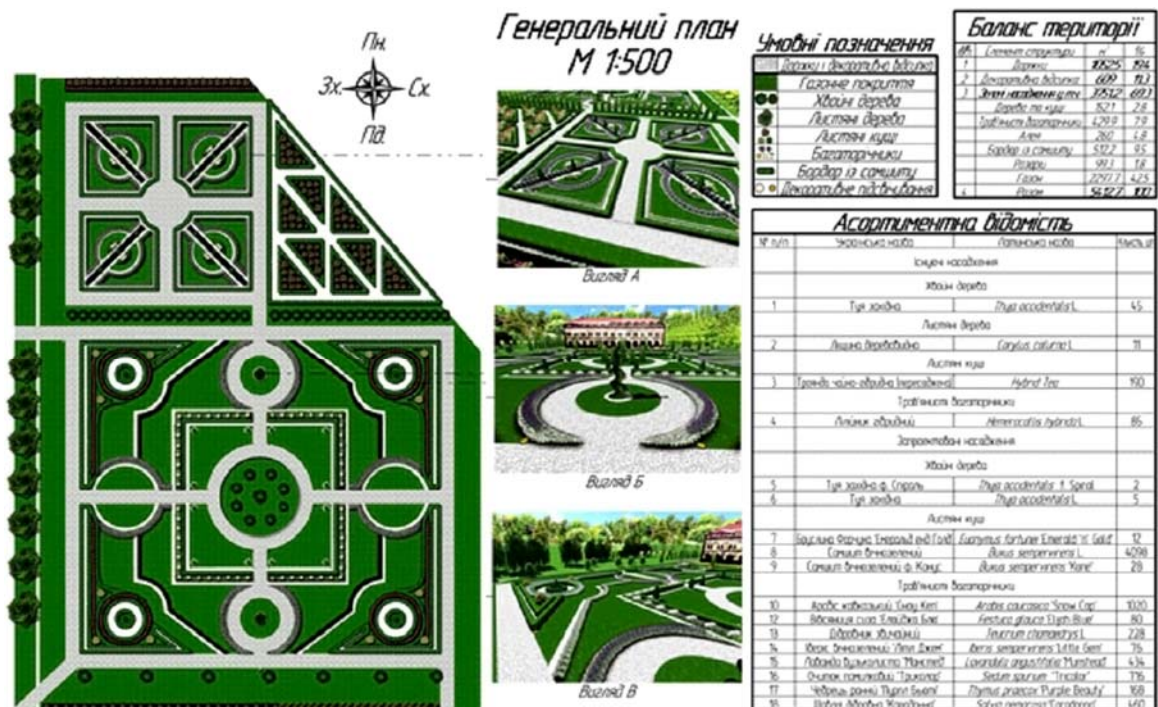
Генеральний план партеру УНУС / The general plan of the parterre of UNUH
